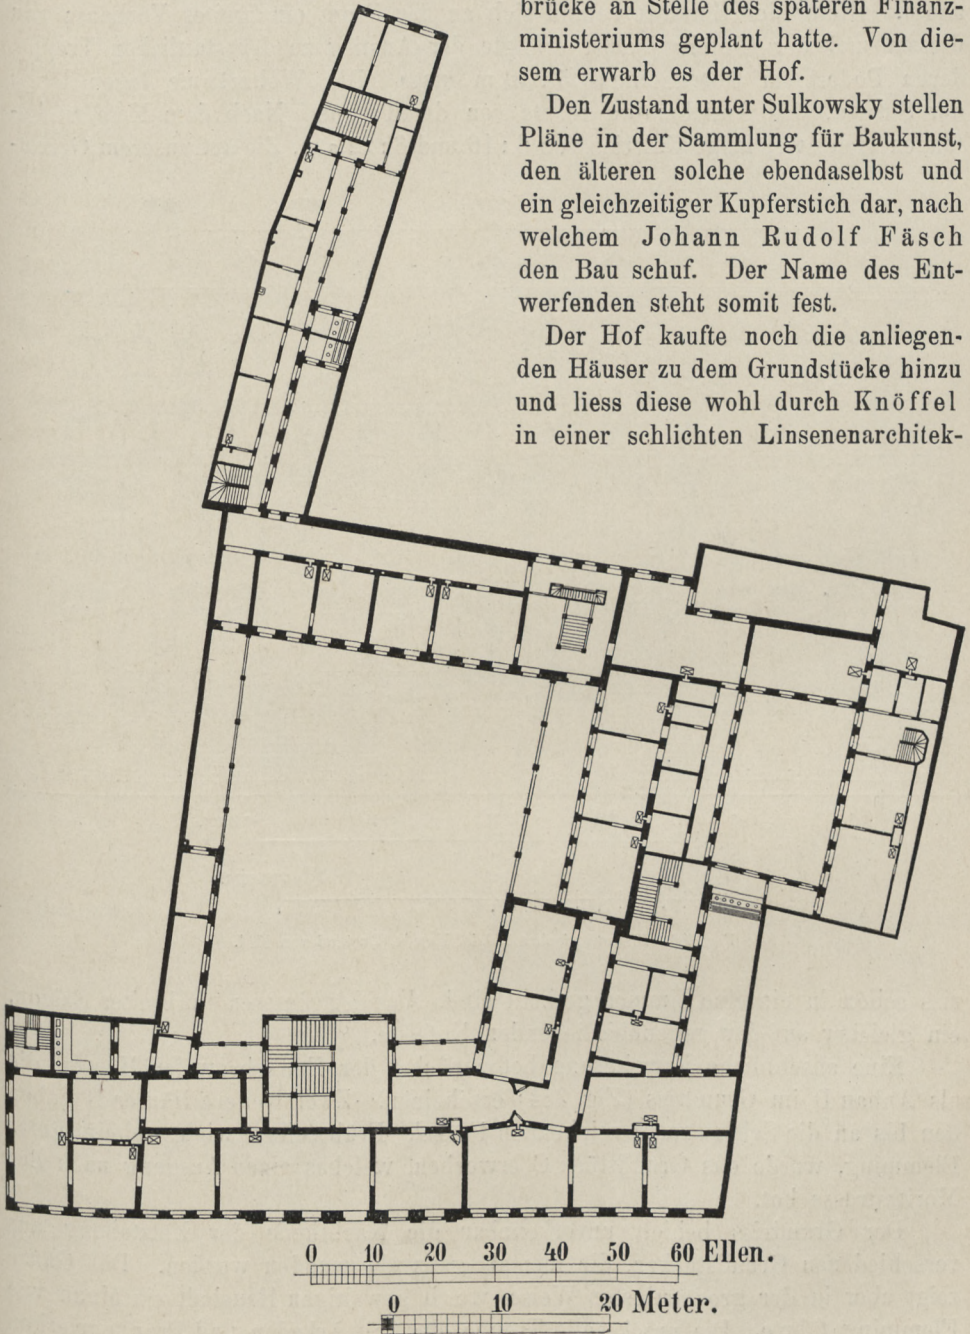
Flemming'sches Palais, Grundriss des 1. Obergeschosses. Zustand von 1747.
